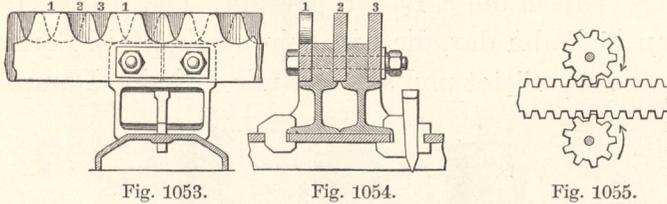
und 1054. Abts dreiteilige Zahnstange (Fig. 1053 Ansicht mit Befestigung auf eiserner Querschelle, Fig. 1054 Querschnitt). Fig. 1055. Wagerichte Verzahnung.
